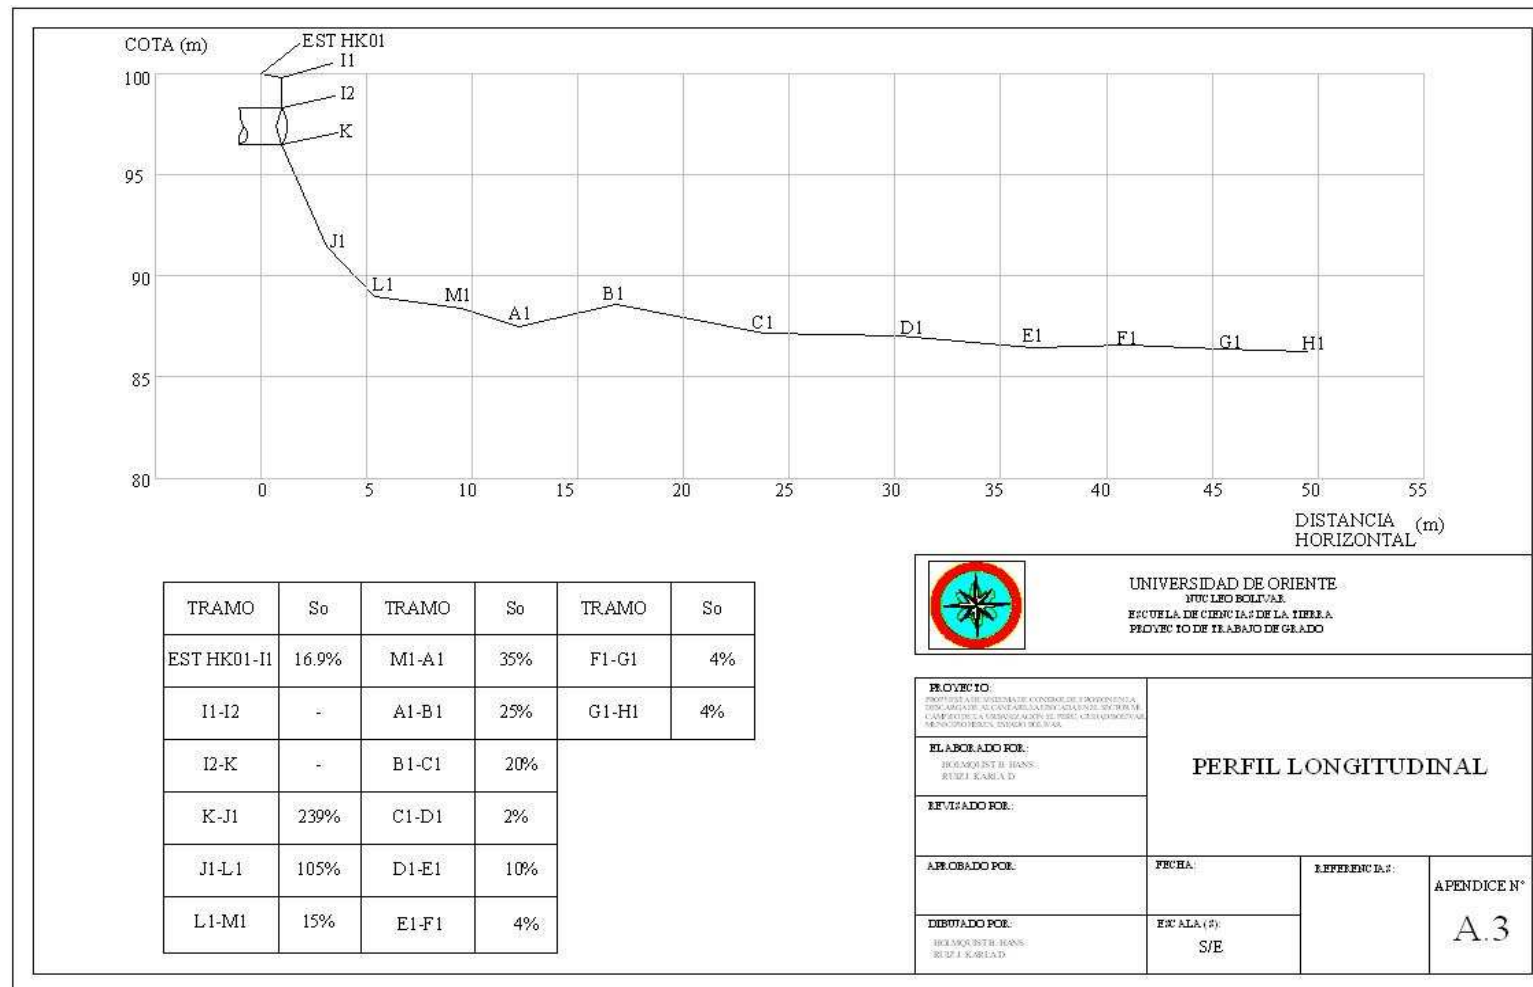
Perfil longitudinal de la cárcava en estudio.
